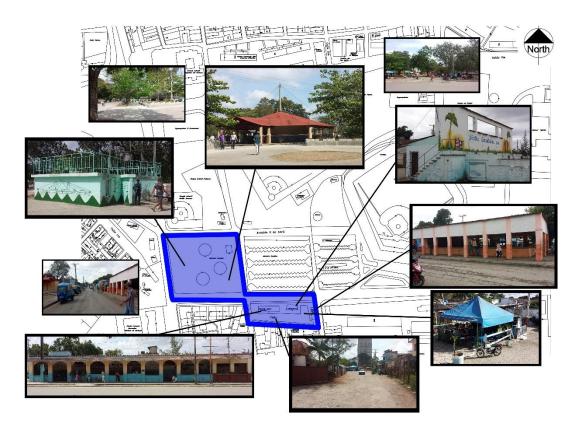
Plan general de la zona actual de proyecto (Fuente: ACAD Santa Clara)
